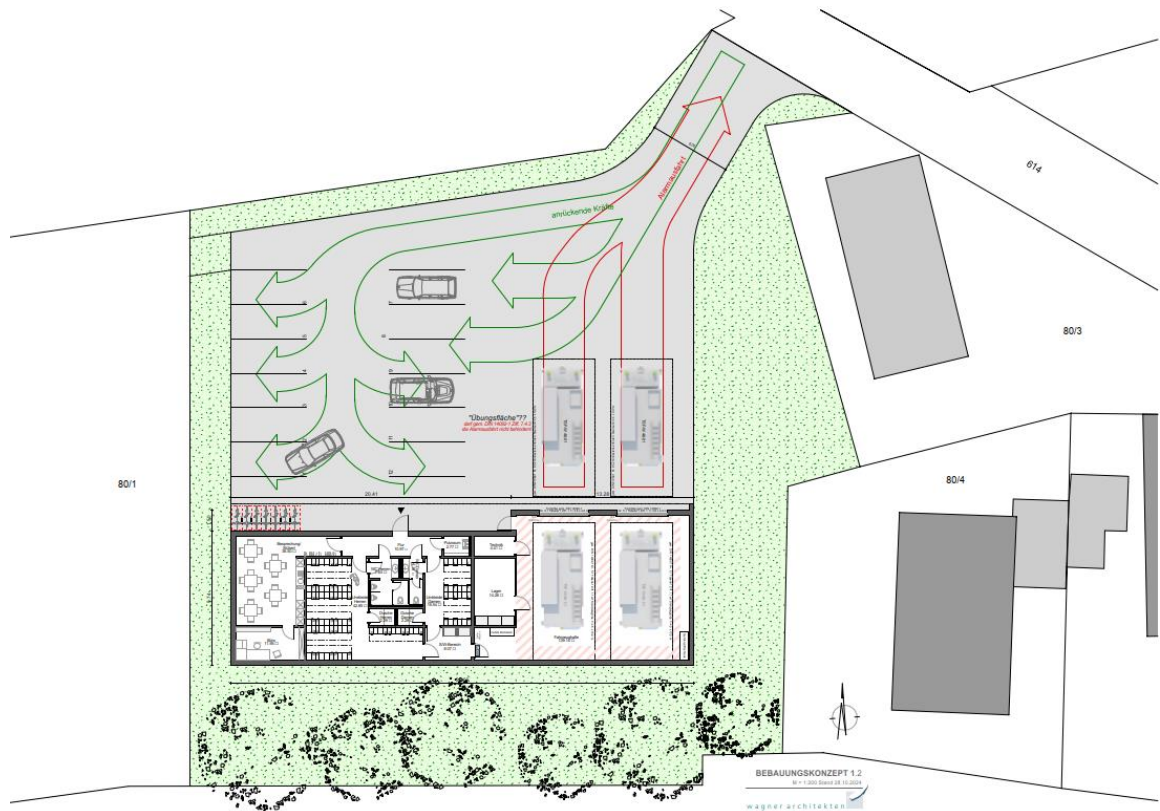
Grundriss mit Außenanlage [a]
